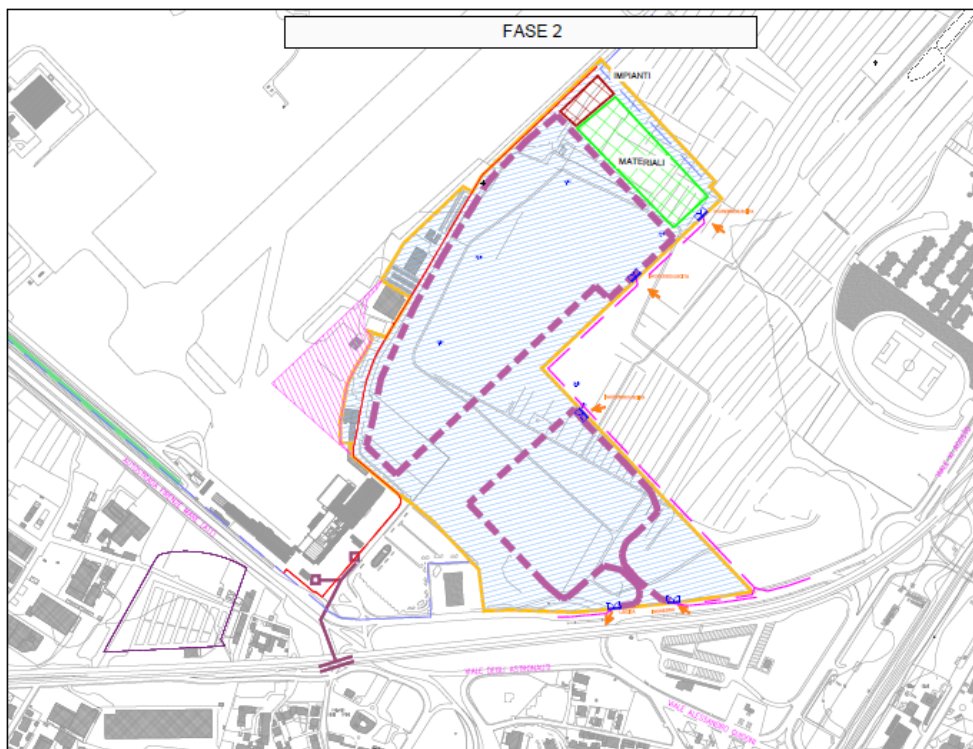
Cantierizzazione dell'Area Nuovo Terminal – Fase 2
